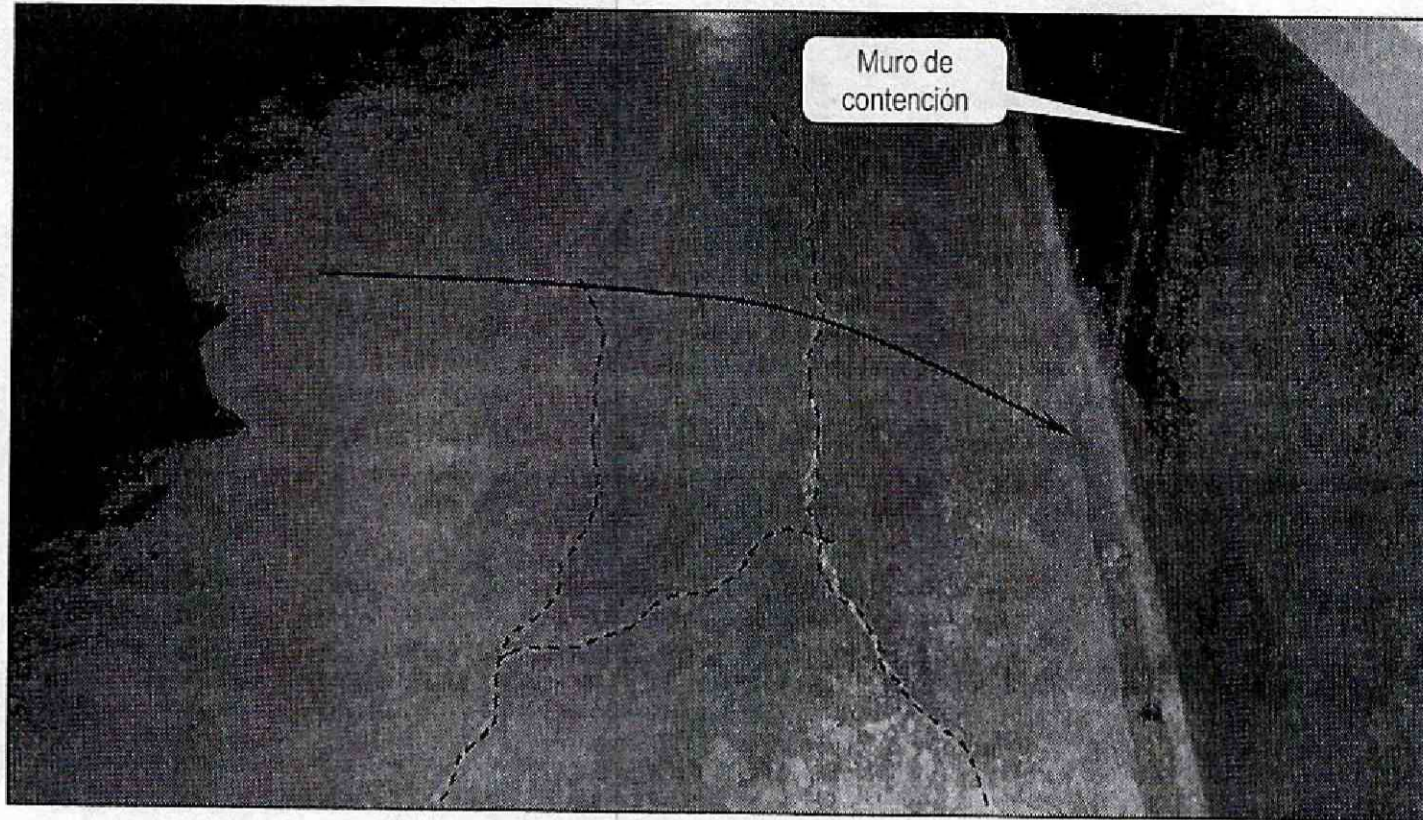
y 4. Vista de las grietas en el muro de contención de la Agrupación de Vivienda Takalí de Piedemonte P.H. emplazada en el predio de la Calle 167 No. 74-32, en el Barrio Casablanca de la Localidad de Suba
